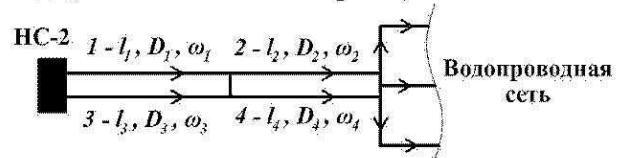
Схема водовода из 2-х ниток с перемычкой
